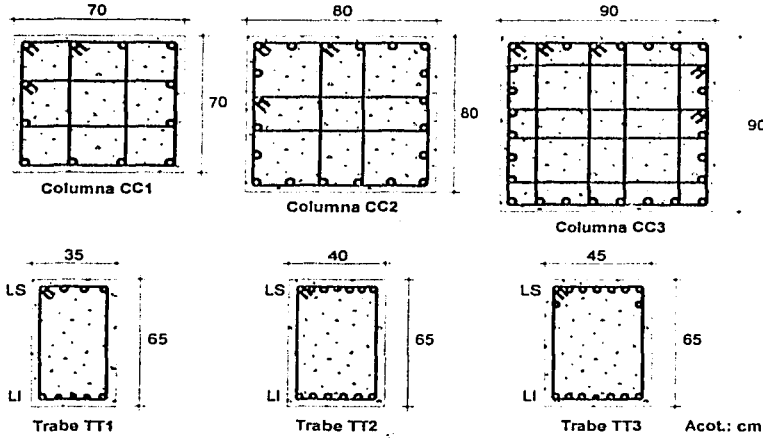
Dimensiones y distribución del armado en elementos estructurales
